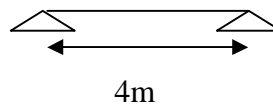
Schéma statique du 4<sup>ème</sup> type de poutrelles.
